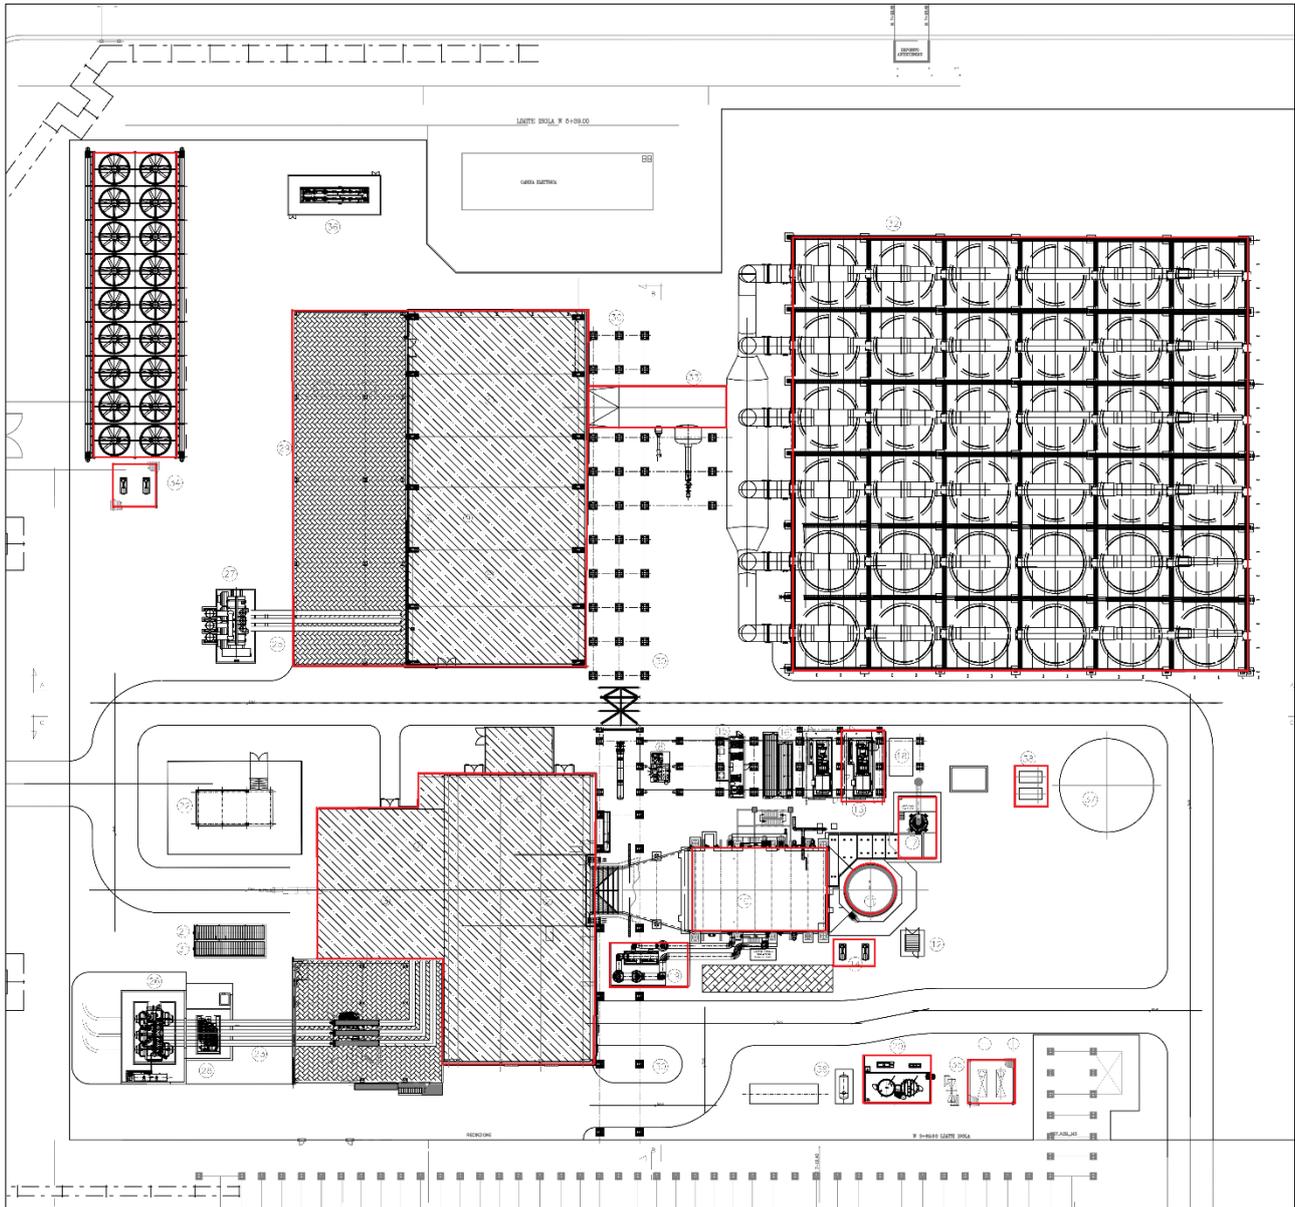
Planimetria degli equipment nella nuova area di progetto
